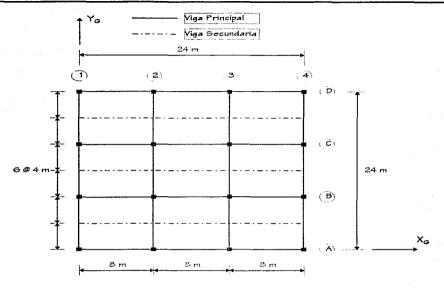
Planta tipo, setructurae de 7 y 17 nivelee
